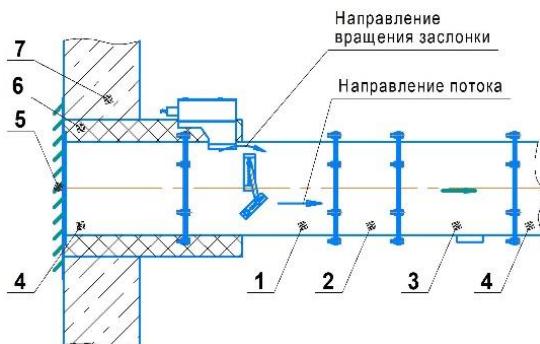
Максимальный вылет заслонки за пределы цилиндрического корпуса клапана
